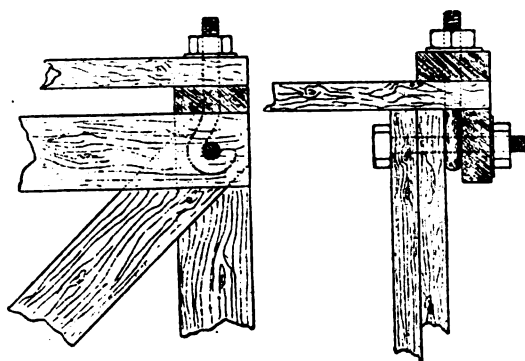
Metodo di connessione delle « poutrelles ». — Vista secondo la lunghezza delle « poutrelles » e vista di fianco.
